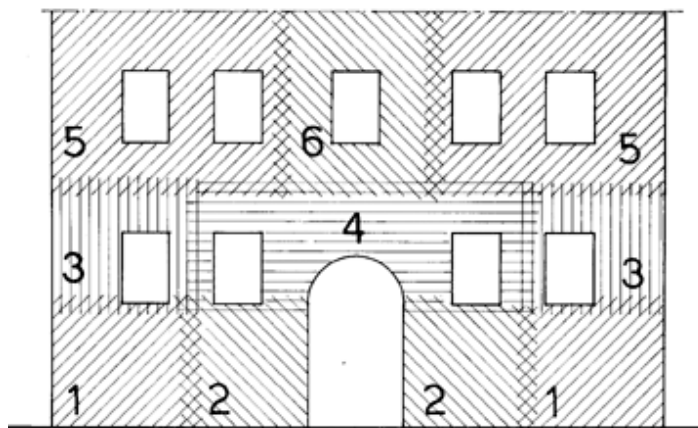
Schema della sequenza di iniezioni su muratura (3).
